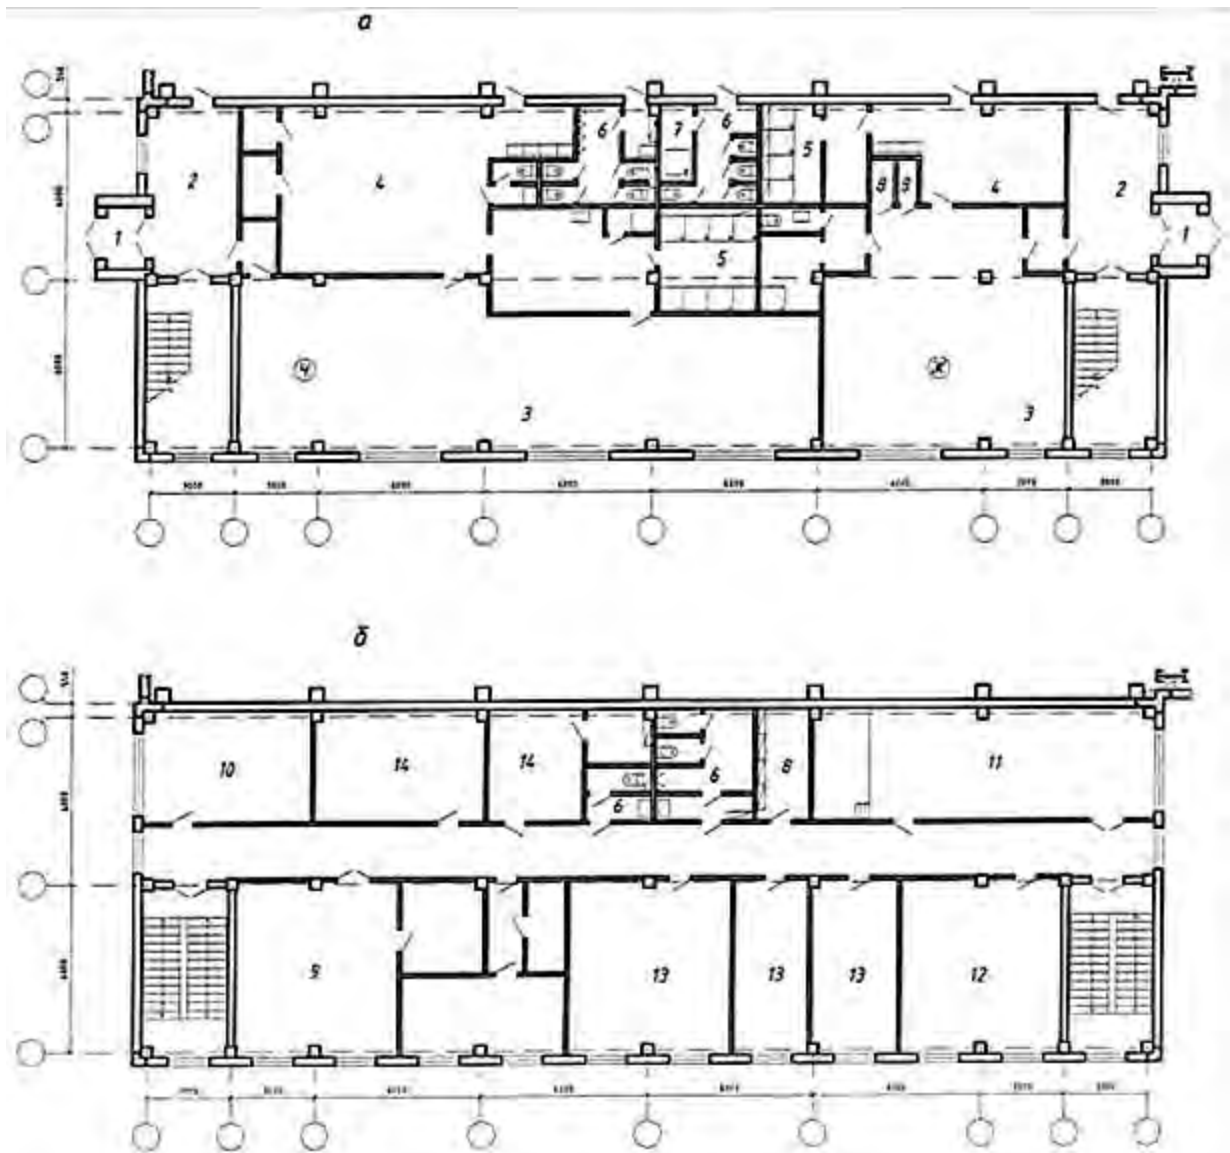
Плани прибудованої каркасно-панельної адміністративної будівлі шириною 12 м з гардеробним блоком роздільного зберігання одягу: а – план першого поверху; б – план другого поверху; 1 – тамбур; 2 – вестибюль; 3 – гардеробні домашнього одягу; 4 – гардеробні спеціального одягу; 5 – душові; 6 – убиральні; 7 – кімната жіночої гігієни; 8 – кладова; 9 – зала їдальні; 10 – медична кімната; 11 – зал зібрань; 12 – приміщення громадських організацій; 13 – приміщення управління і конструкторського бюро; 14 – підсобні приміщення
